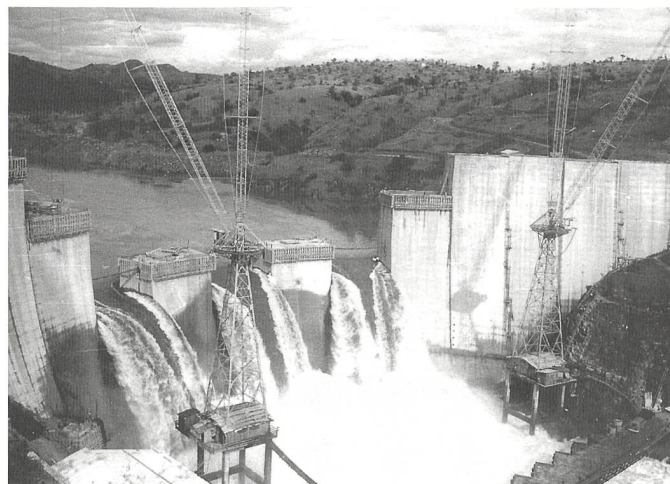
Construction du barrage de Cambambe, 1959-1963.
